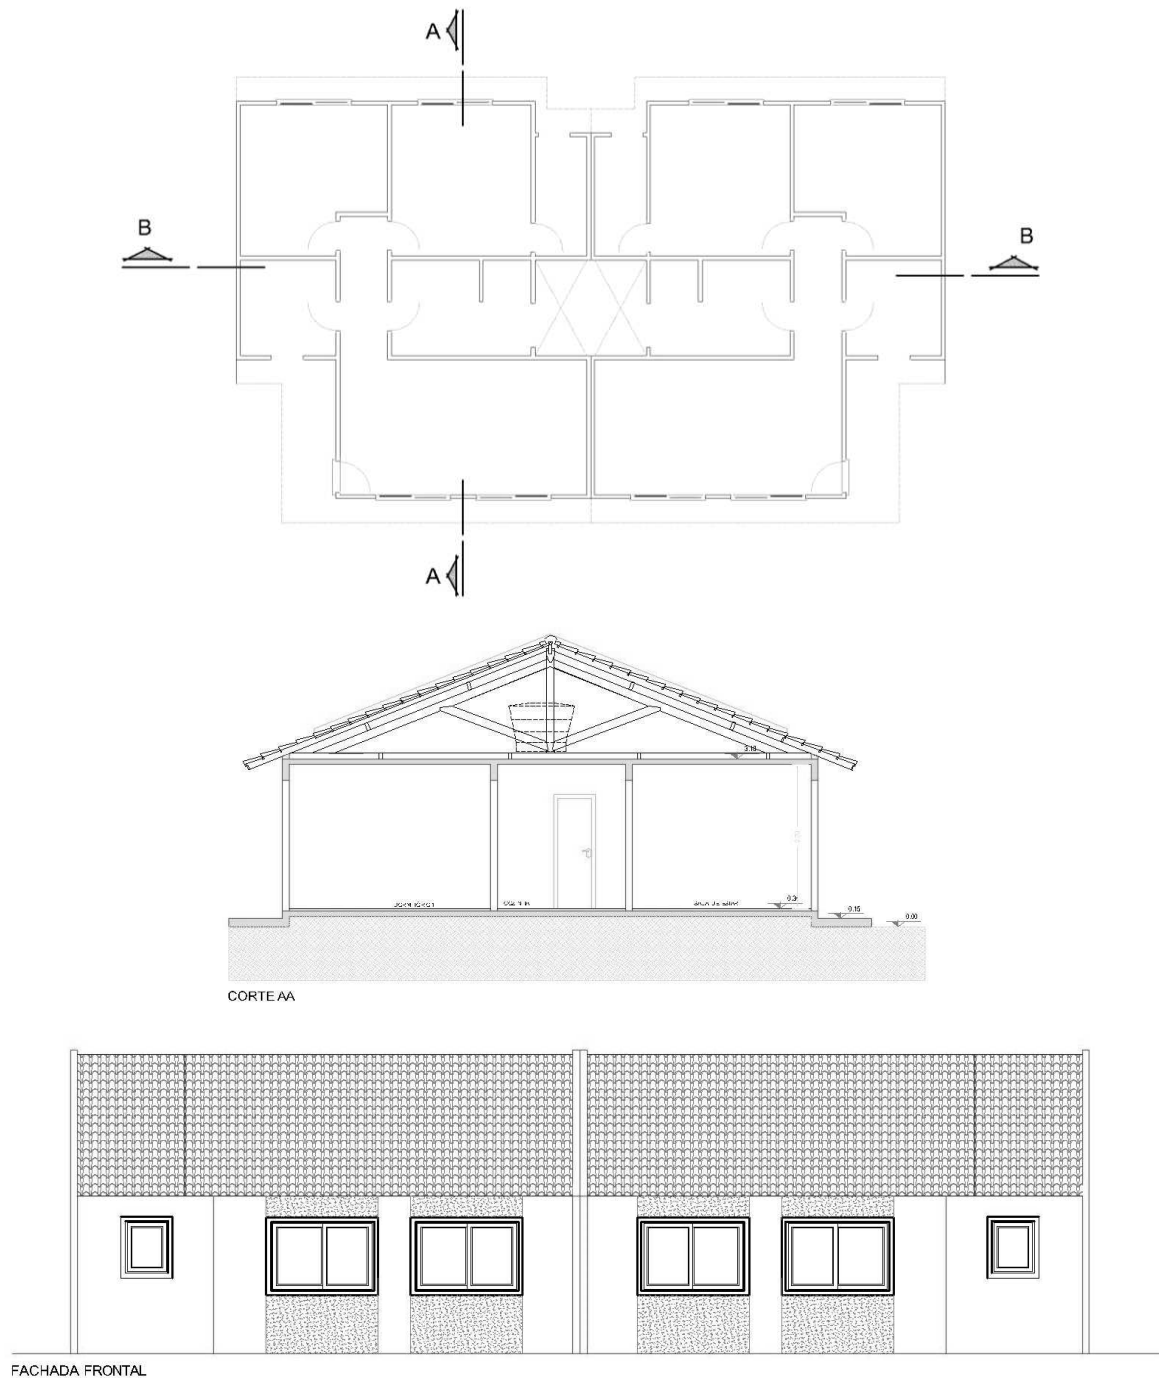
Planta baixa, corte e fachada principal da edificação tipo UH1
